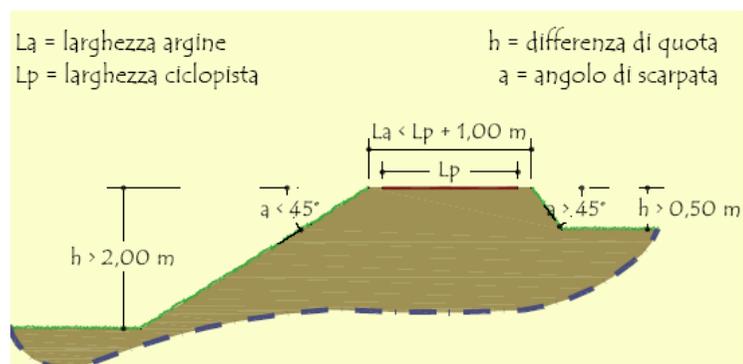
Piste ciclabili – Condizioni per installazione parapetto
